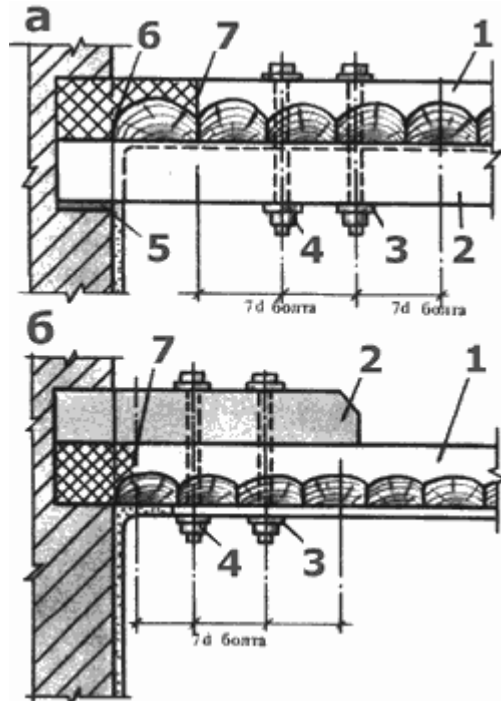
Укрепление балок подбалками снизу (а) и сверху (б): 1 - балка перекрытия; 2 - подводимая подбалка; 3 - шайба; 4 - болты крепления; 5 - прокладка из просмоленной доски; 6 - ослабленная часть балки; 7 - граница загнивания.
